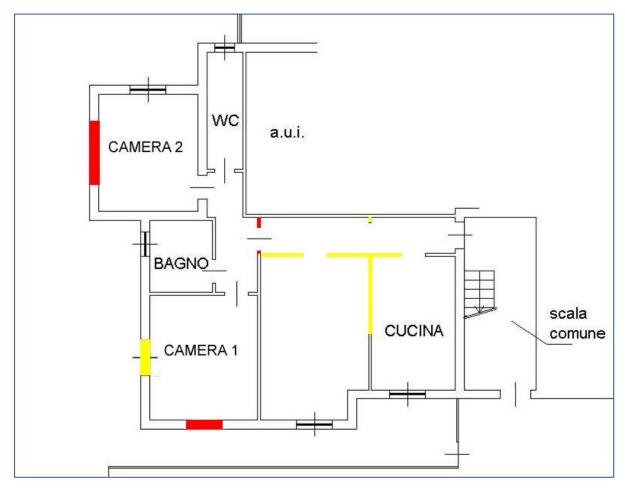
schema planimetrico delle demolizioni (giallo) e costruzioni (rosso)
